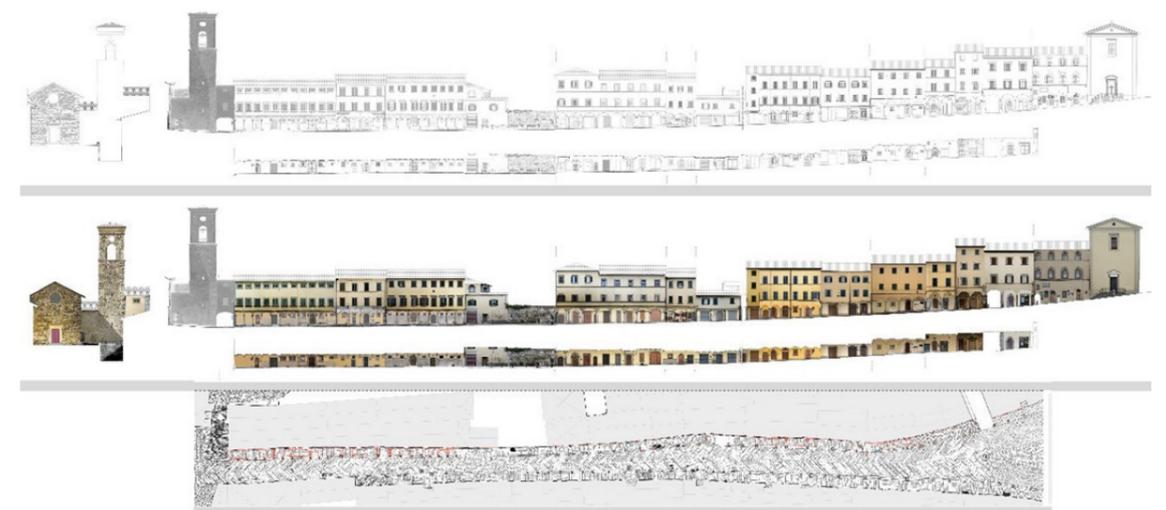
Rilievo del centro urbano di Poppi, Pianta e prospetti di via Cavour.
